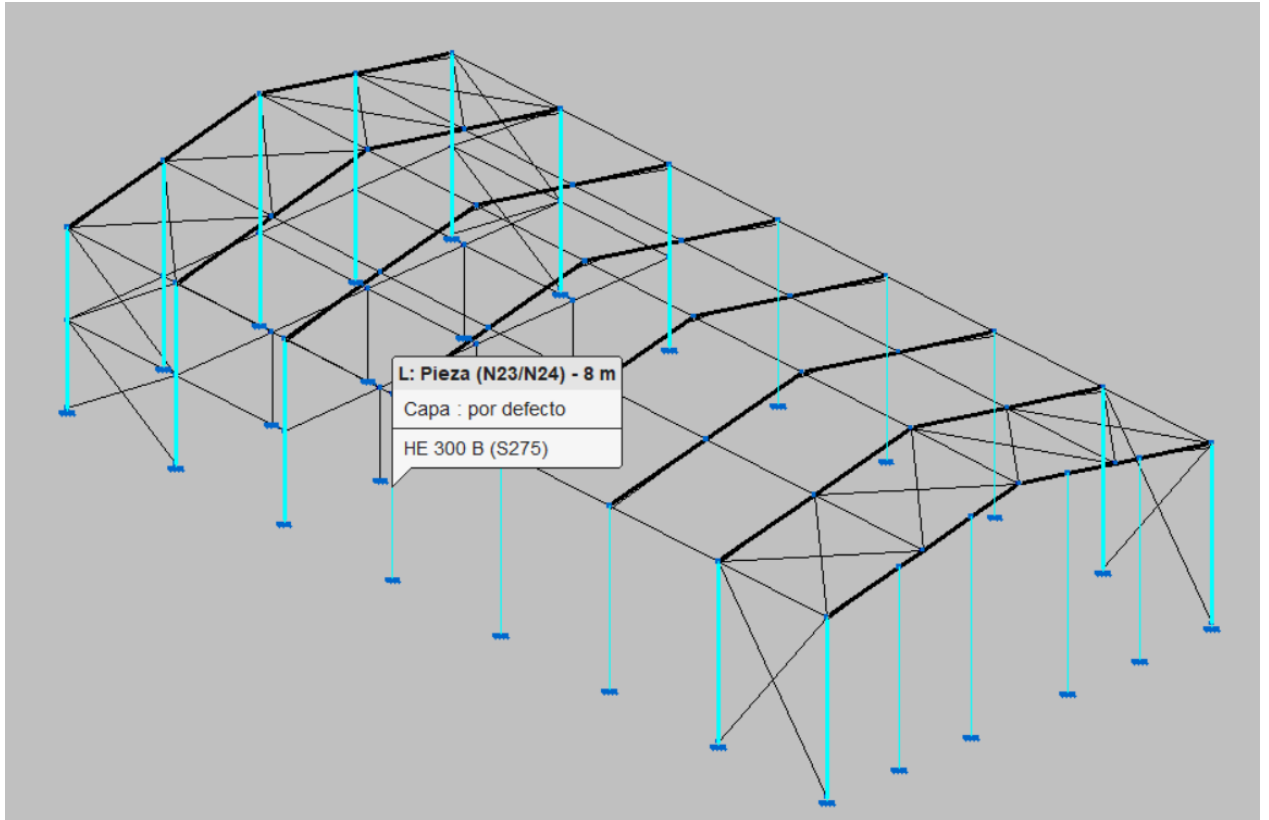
Pilares HEB 300 (Fuente: Cype)
